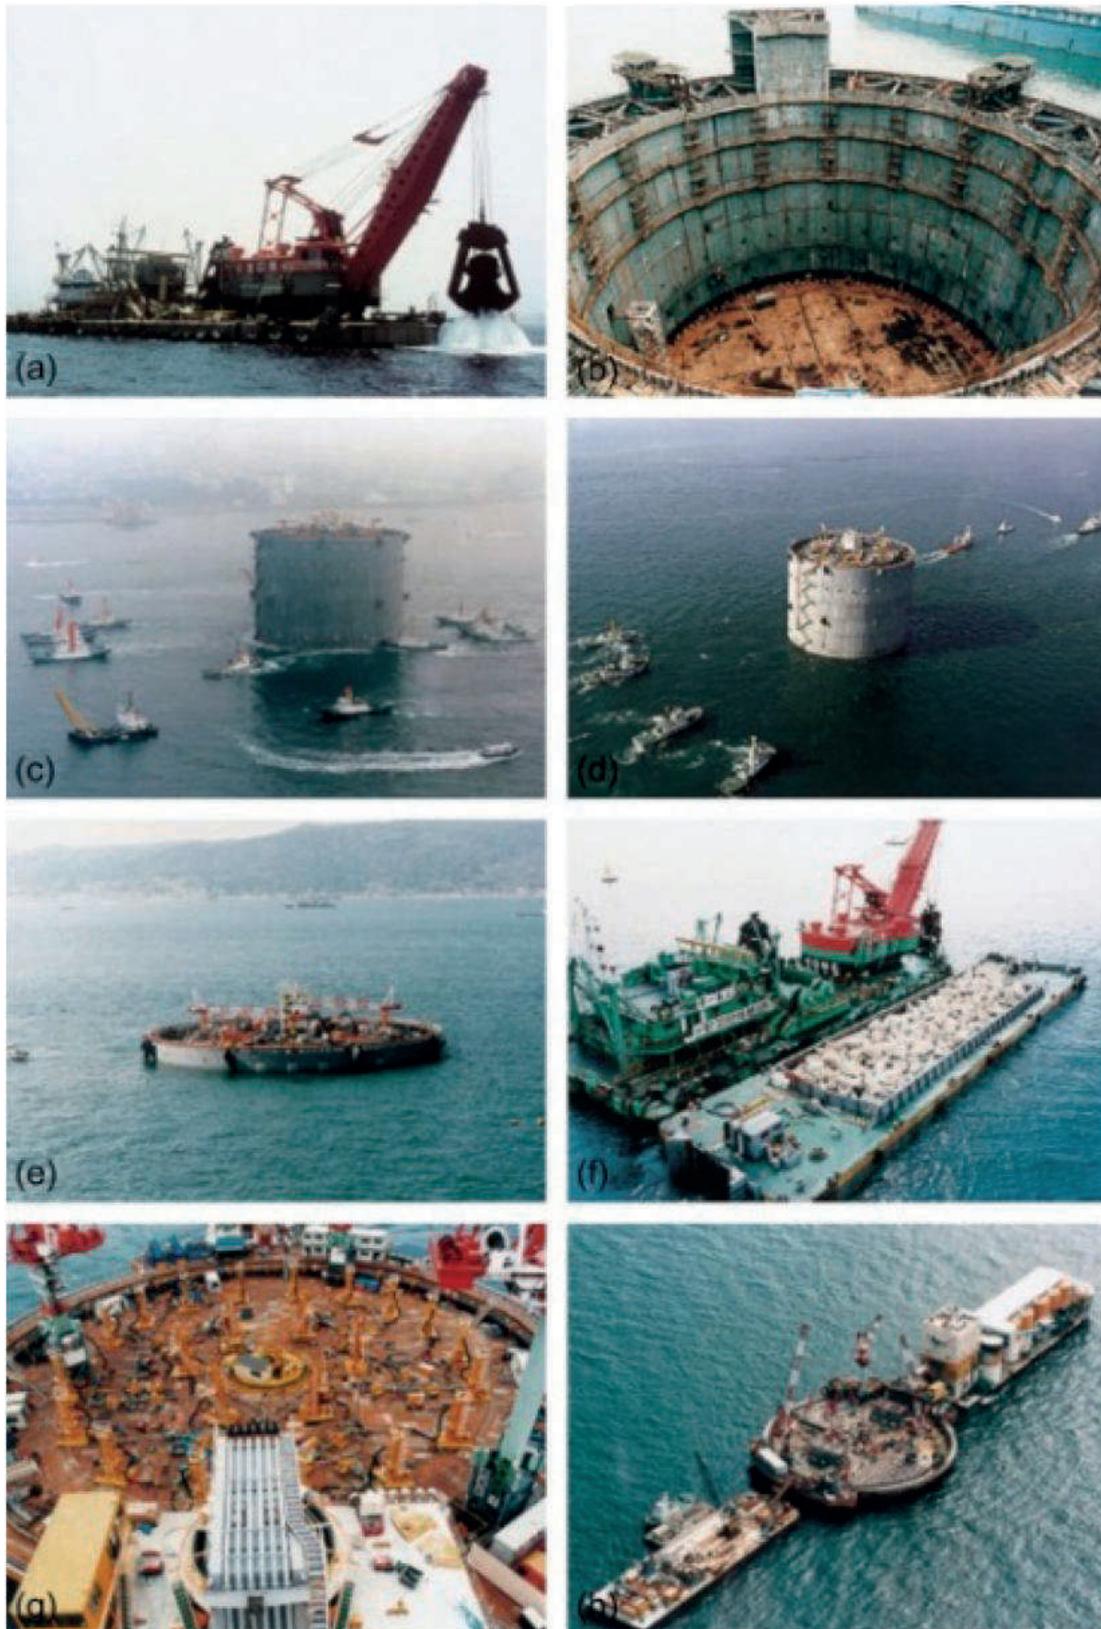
Fasi di realizzazione delle fondazioni dell’Akashi-Kaikyo Bridge [44][45].
